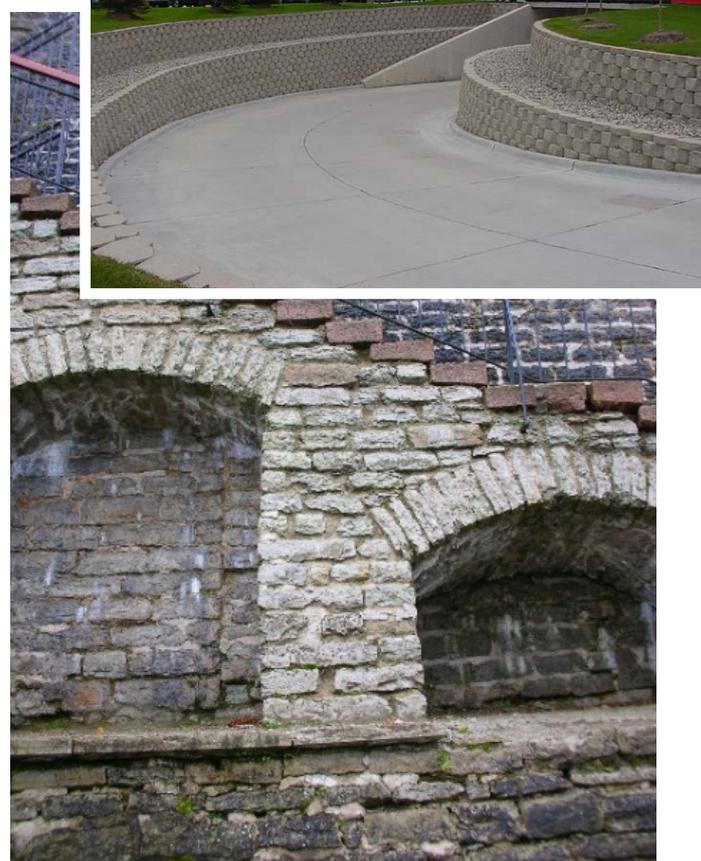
Интересные формы и решения подпорных сооружений: стена из армированного грунта с выпуклой лицевой поверхностью (вверху) и тонкие заанкеренные в грунт стенки, укрепляющие поверхность откоса
